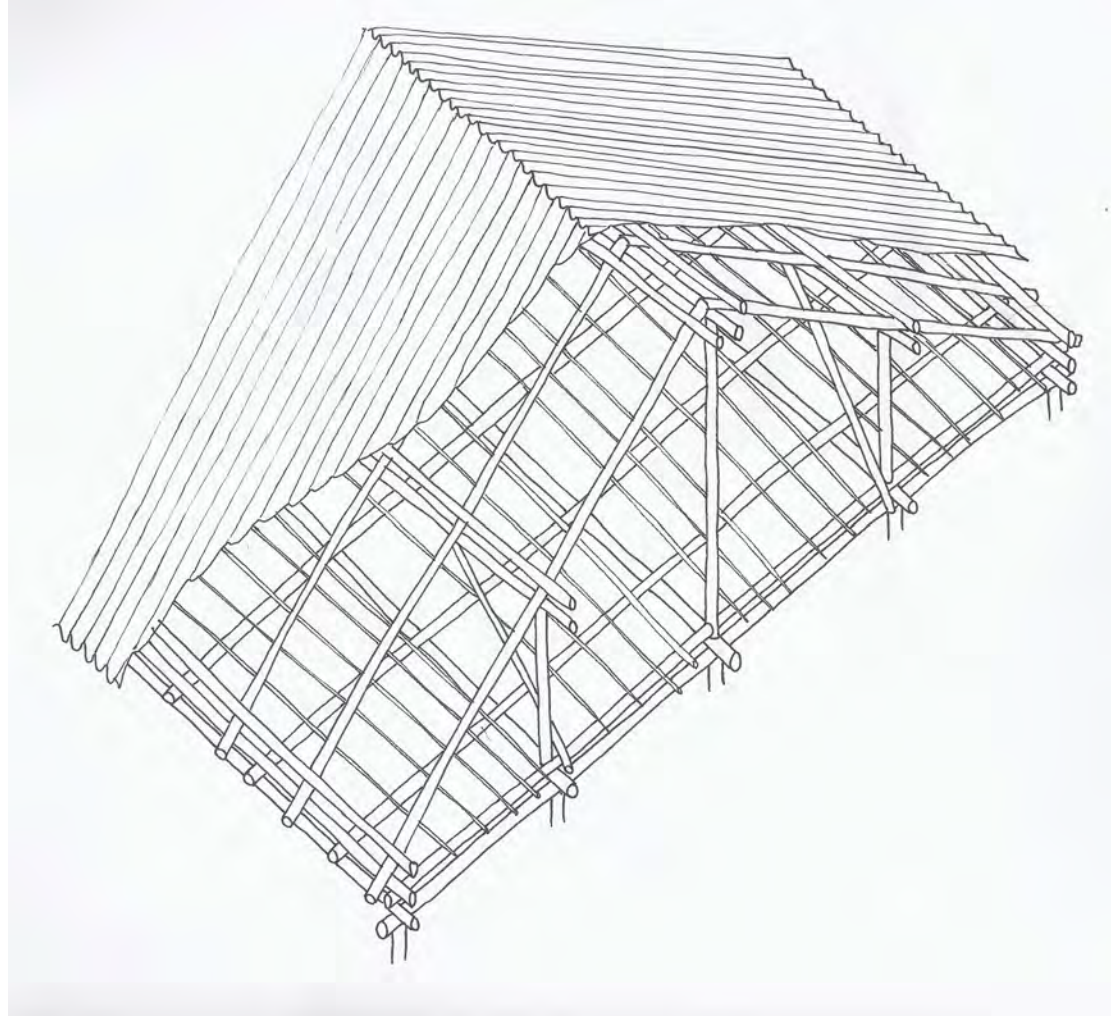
Cubierta de un secadero de estructura de madera y piel vegetal. La cubierta que más se utiliza actualmente es la chapa ondulada de fibrocemento.
